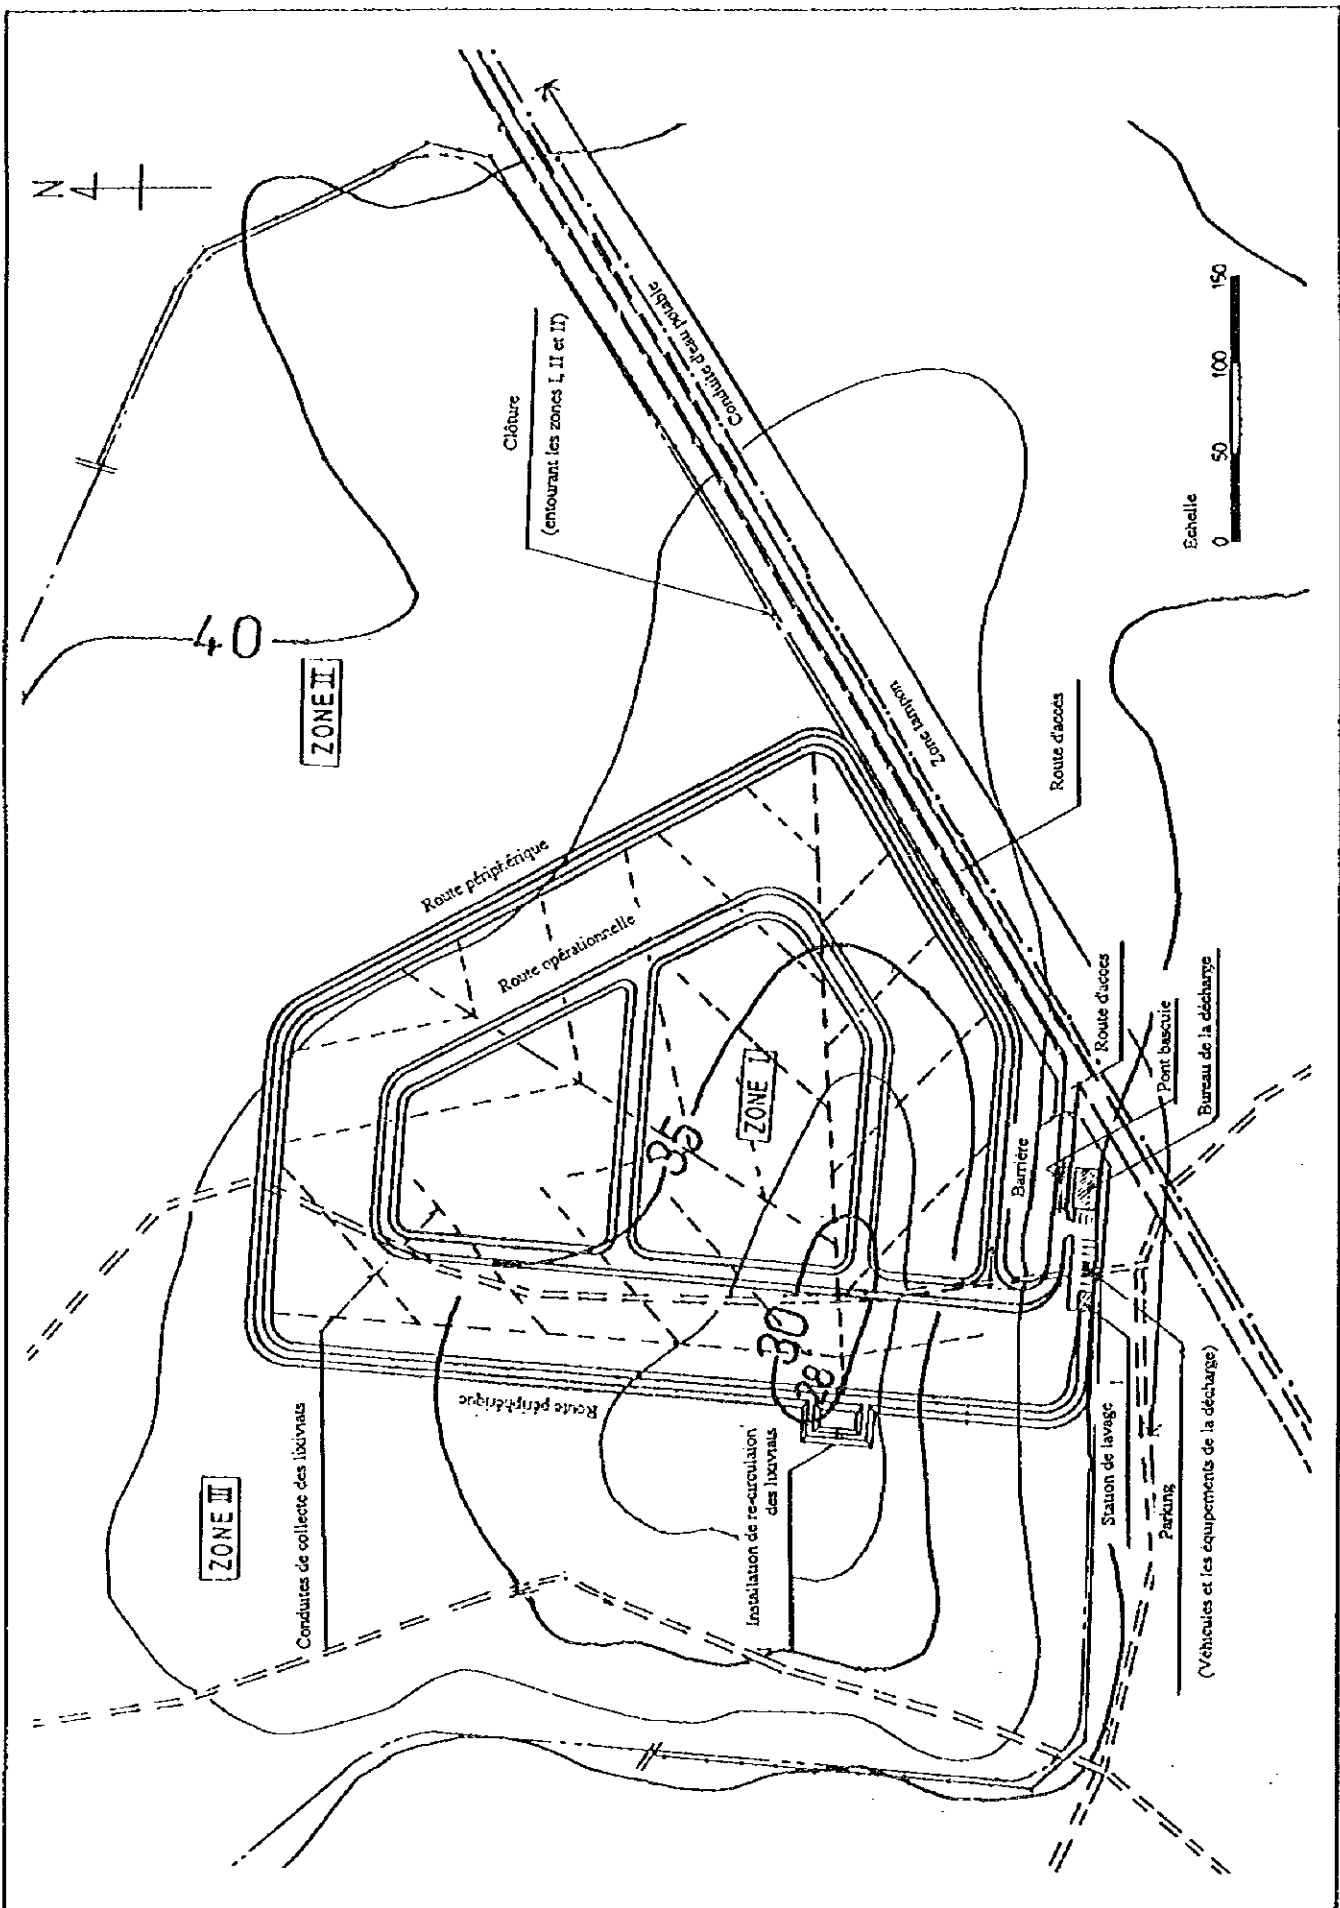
| Plan des installations de la déchèterie de Bettioua (Zone I)
